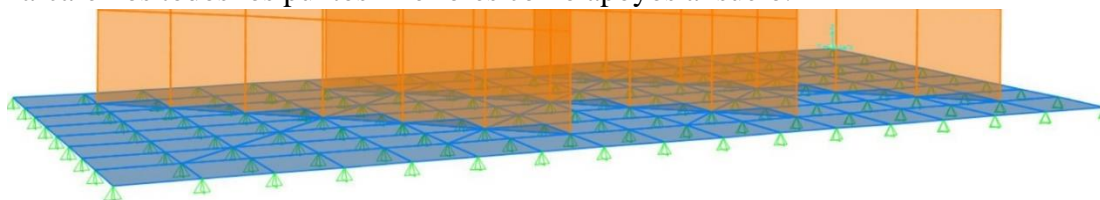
Apoyos de la estructura. Autor: Elaboración propia.
